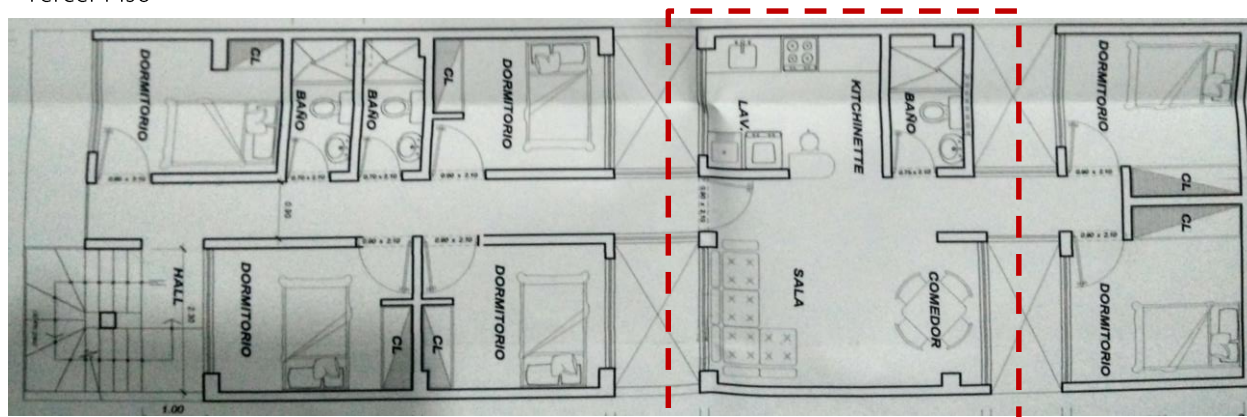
Planta del tercer piso. Recuperado: Entrevista, 2017.
